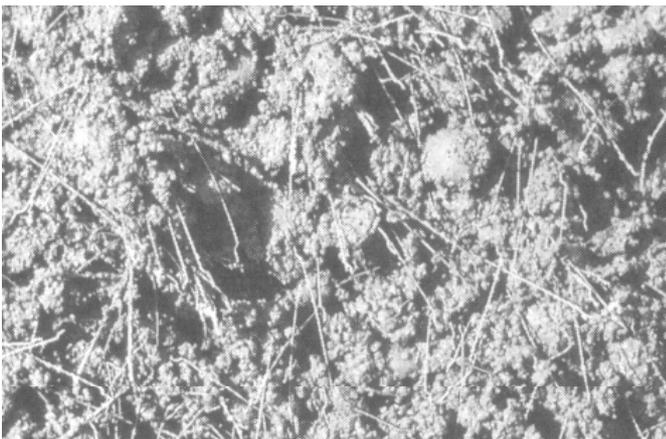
Im Beton „gleichmässig“ verteilte Stahlfasern [29]
